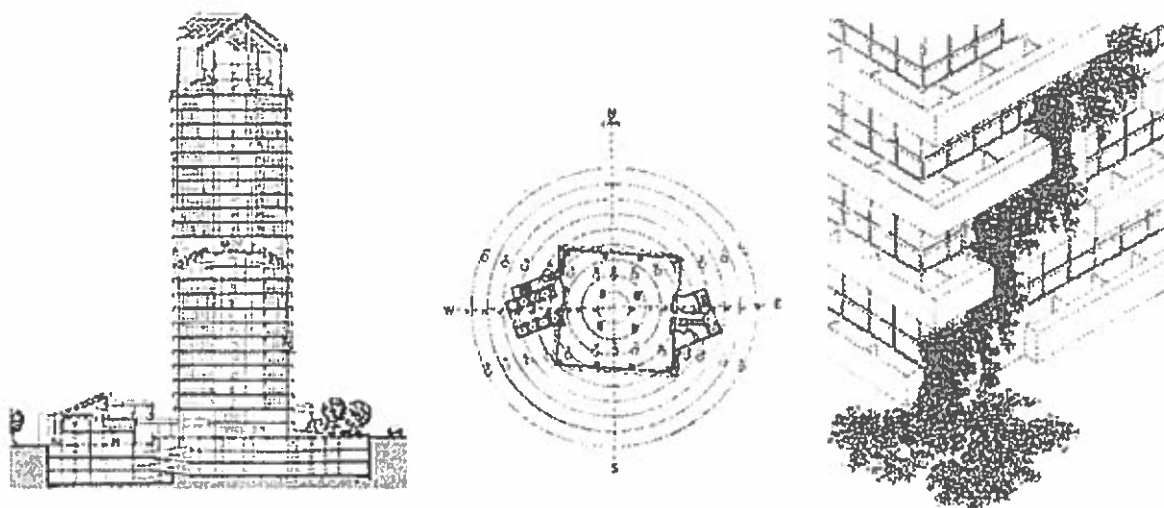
IBM Plaza – Corte, orientação solar e pormenor
